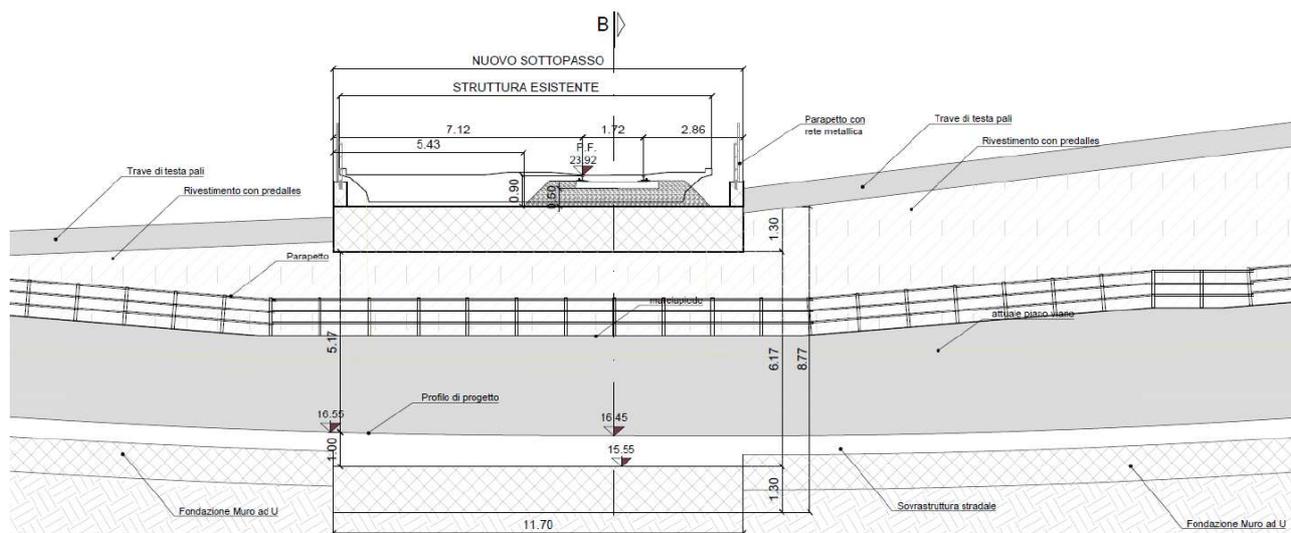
Sottovia ferrovia – Sezione longitudinale
